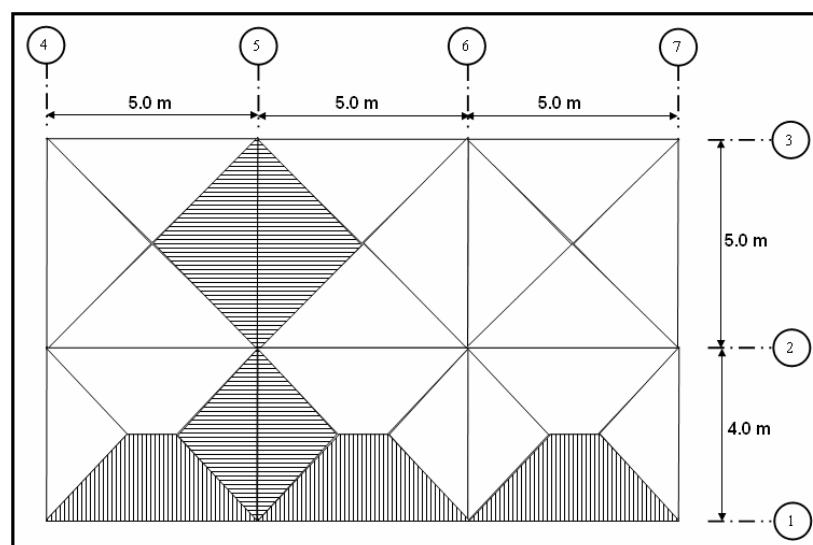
Vista en planta de un edificio que tiene 7 pórticos ortogonales
